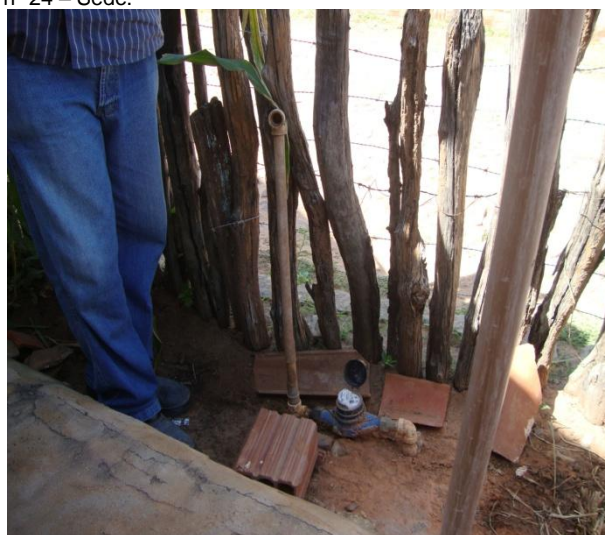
Medição de pressão na Rua Mauro Cavalcante, nº 1675 – Viçosa.
